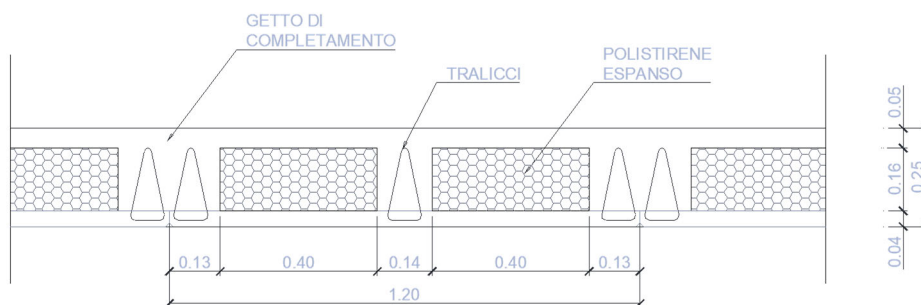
SEZIONE TIPO DEL SOLAIO DELLA PALAZZINA UFFICI
